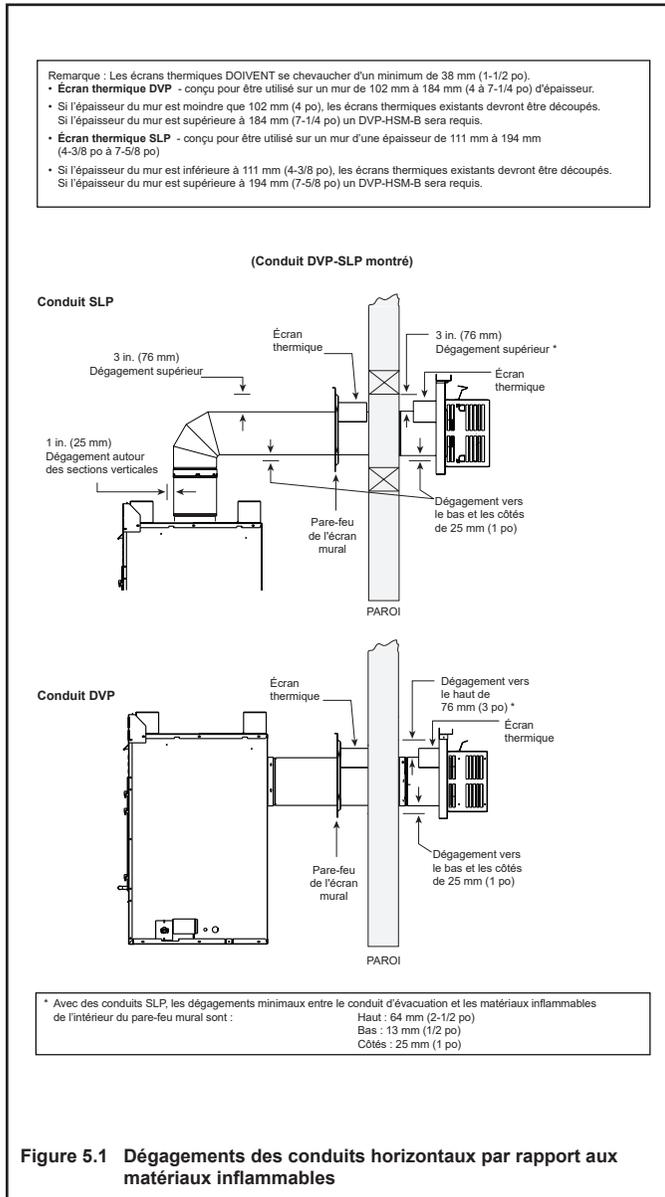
Dégagements des conduits horizontaux par rapport aux matériaux inflammables
